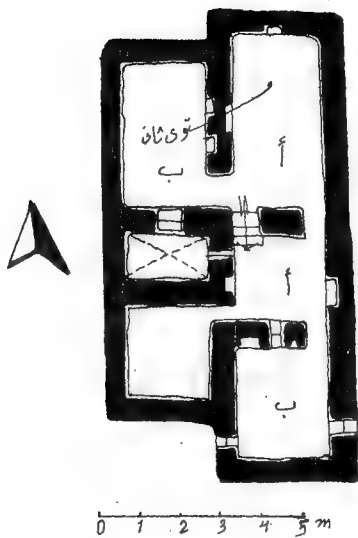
منزل محمد زيهان الدور الأول - مسقط أقي
